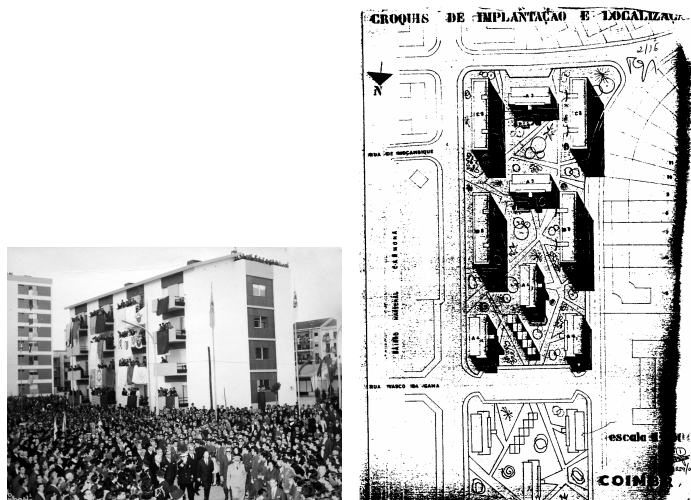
Bairro da FCP-HE em Coimbra (imagem da inauguração e planta do conjunto)
